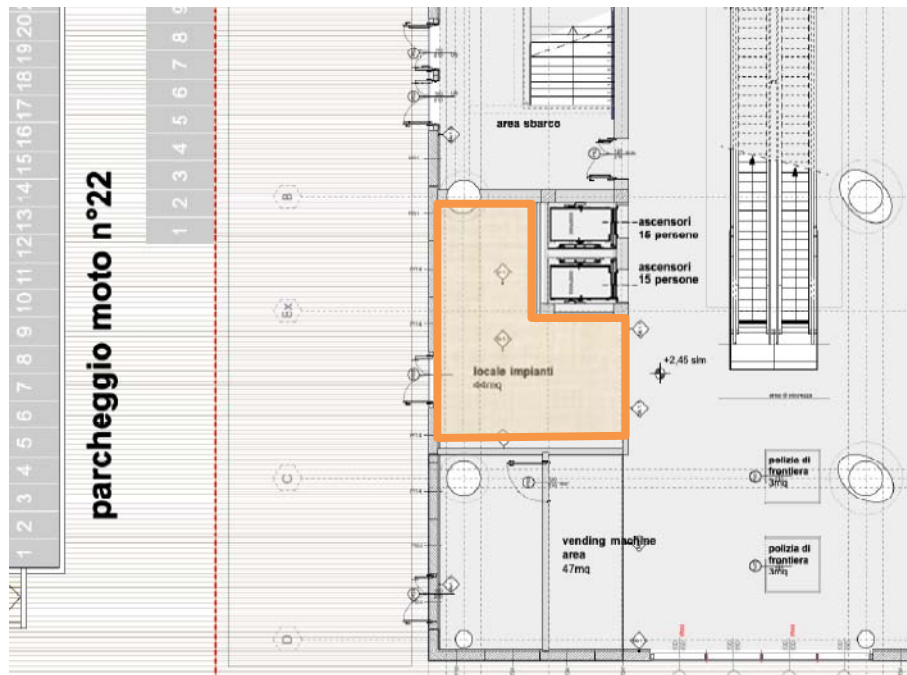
Piano terra, lato nord: locale impianti (planimetria), superfici a parete ed a soffitto di trattamento acustico su cui si deve applicare il materiale fonoassorbente
